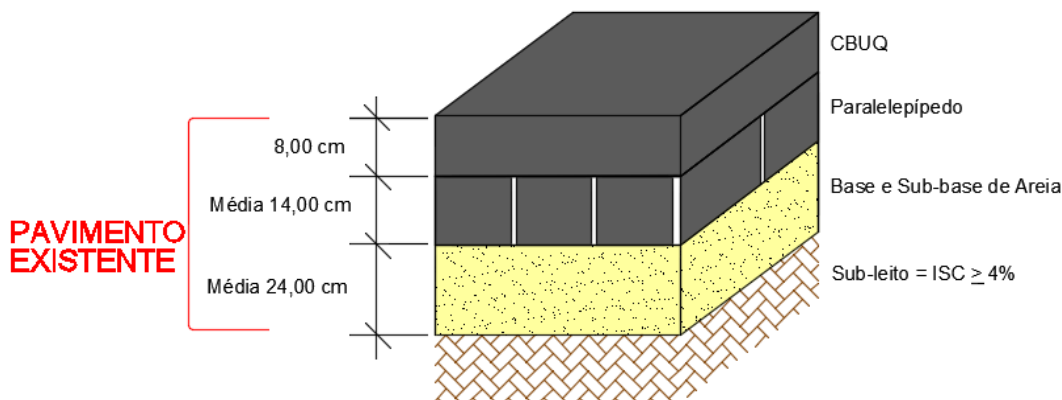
Seção do Pavimento Existente para o segmento 01 e 02
